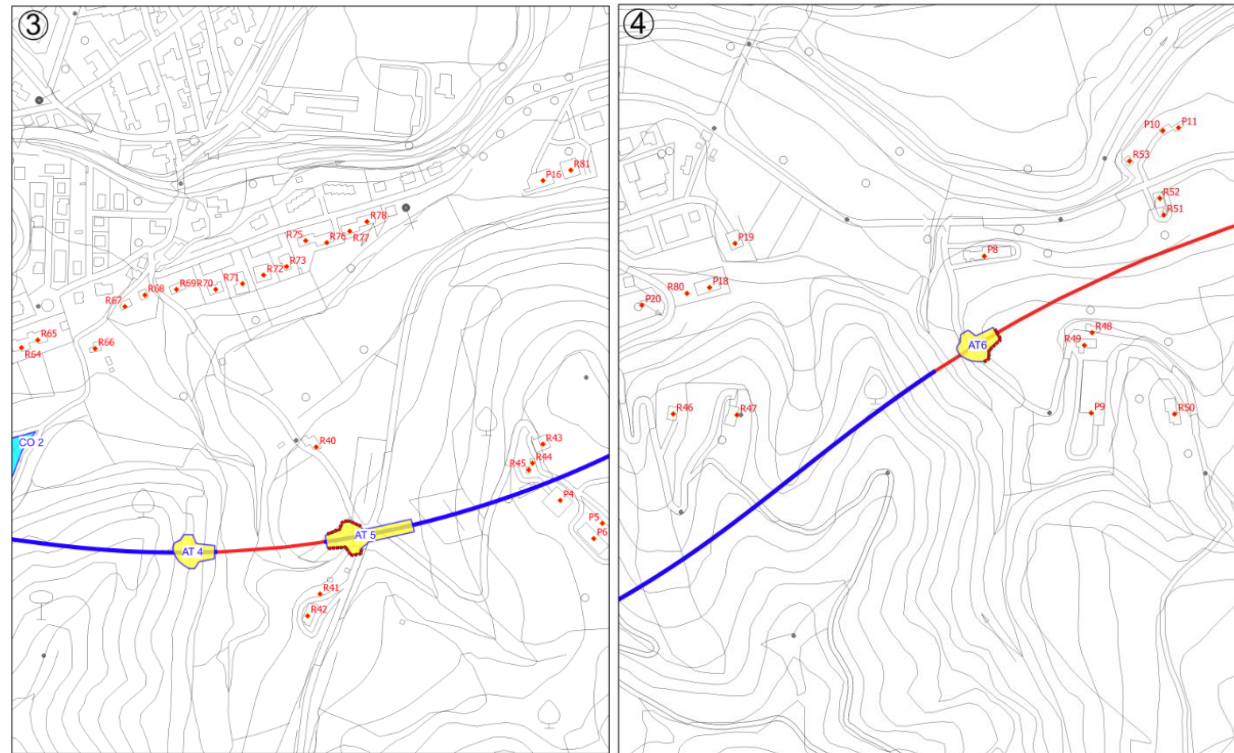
Cantieri AT5 e AT6 con barriere (linea rossa con tratteggio).
